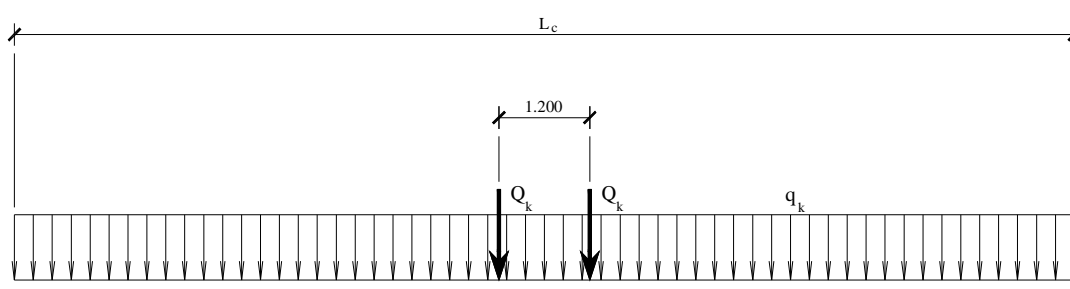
Schema generale della disposizione longitudinale di carico
